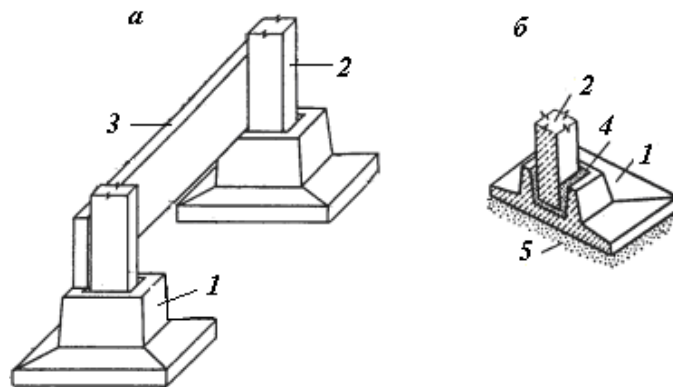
Стовпчасті фундаменти під колони: а – збірний фундамент із башмака стаканного типу; б – розріз; 1 – башмак стаканного типу; 2 – збірна залізобетонна колона; 3 – цокольна панель; 4 – цементний розчин; 5 – піщана підготовка
